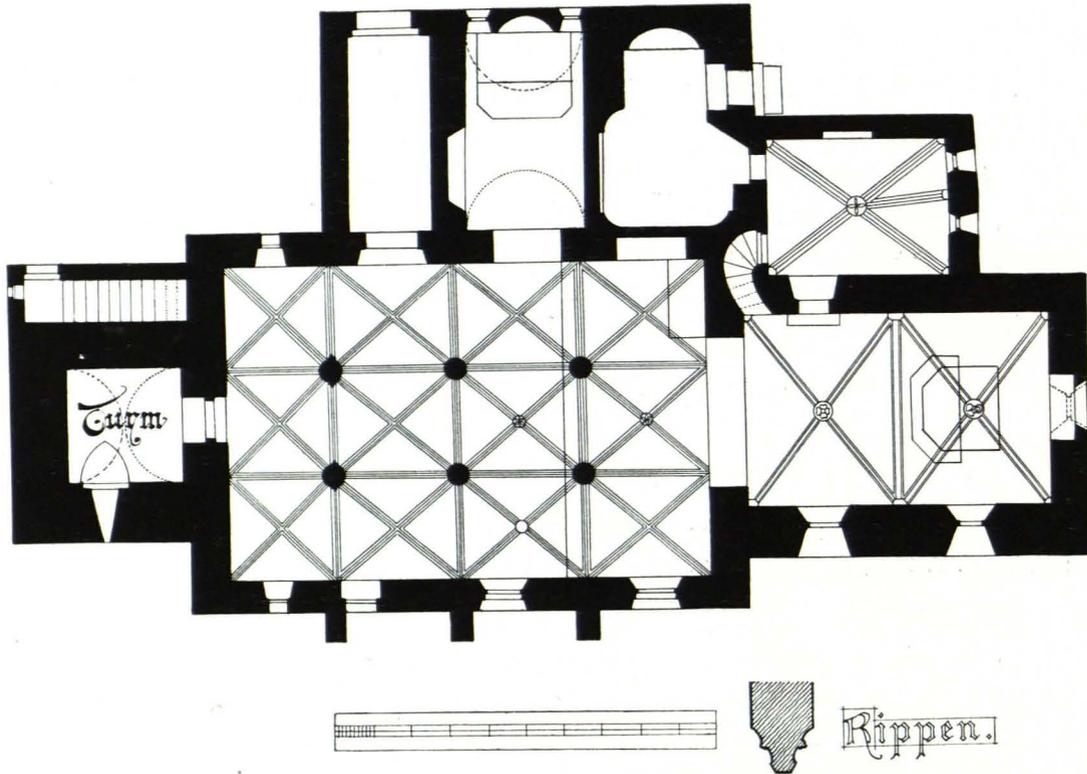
Münichreith, Pfarrkirche, Grundriß 1 : 200 (S. 119)
